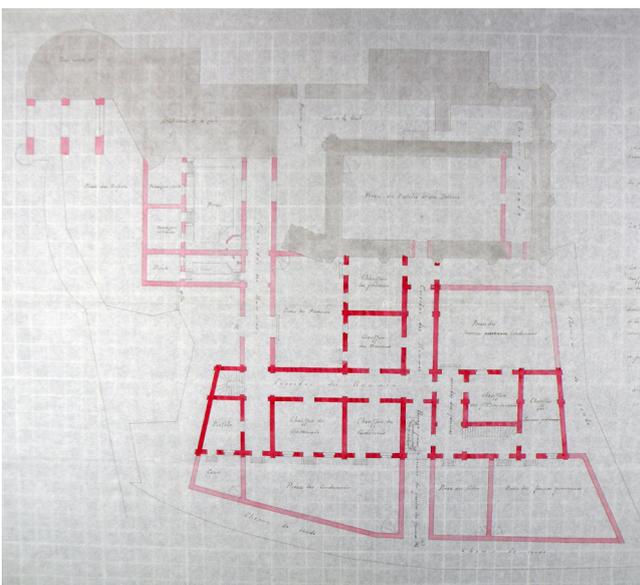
plan du projet de construction de nouvelles prisons de A.-J. Baillargé, 1850 (ADIL 4N99)
